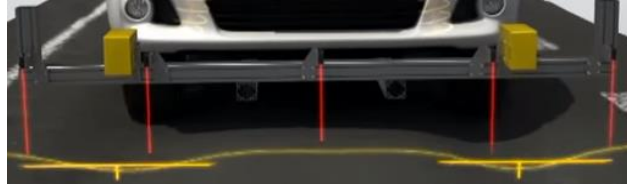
Medição da irregularidade transversal através do Perfilômetro Laser (Pavetesting. (2012). PAVEPROF Laser Profilometer Pavetesting Web. Disponível em: https://www.youtube.com/watch?v=rcDFVxcb__Q)
